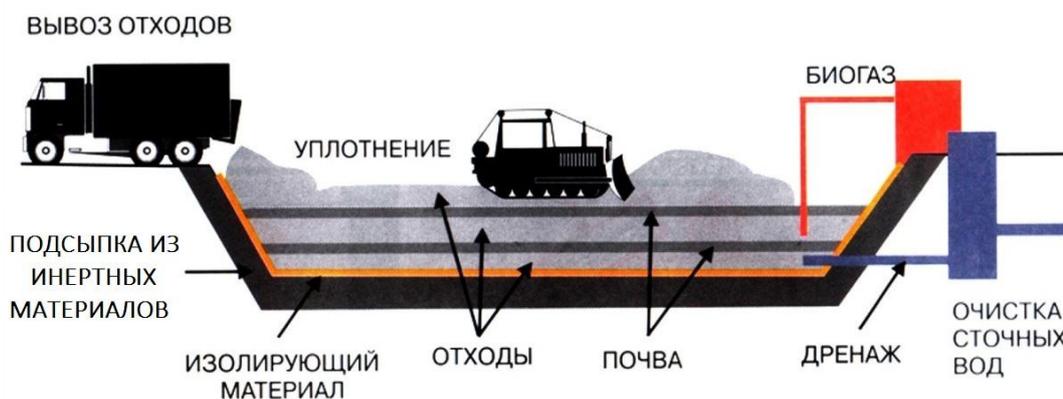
Схема гидроизоляции полигона ТКО
